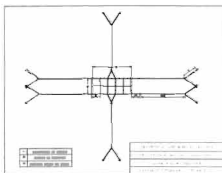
Plano de la estructura completa en el sistema de jaulas.
